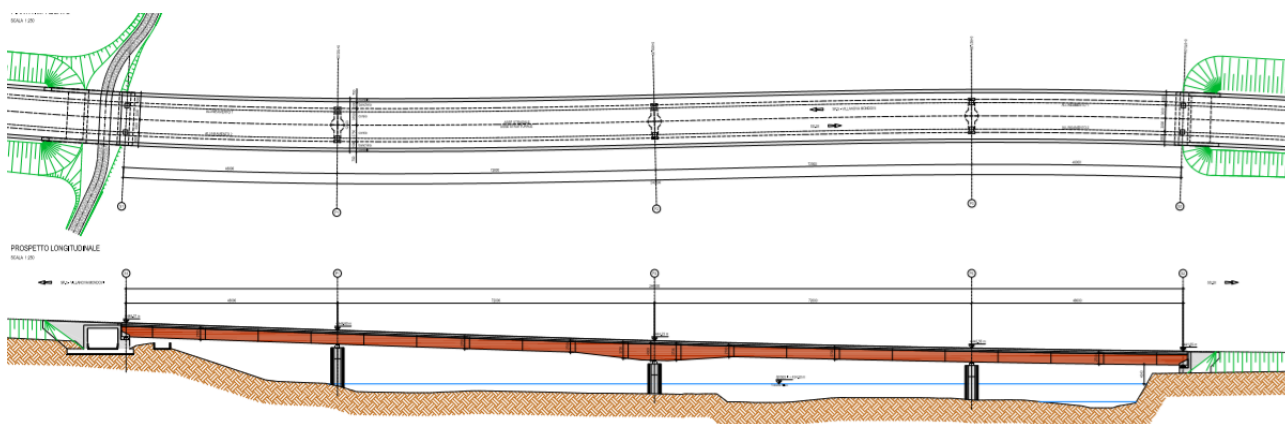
Viadotto Ellero - planimetria e profilo longitudinale
